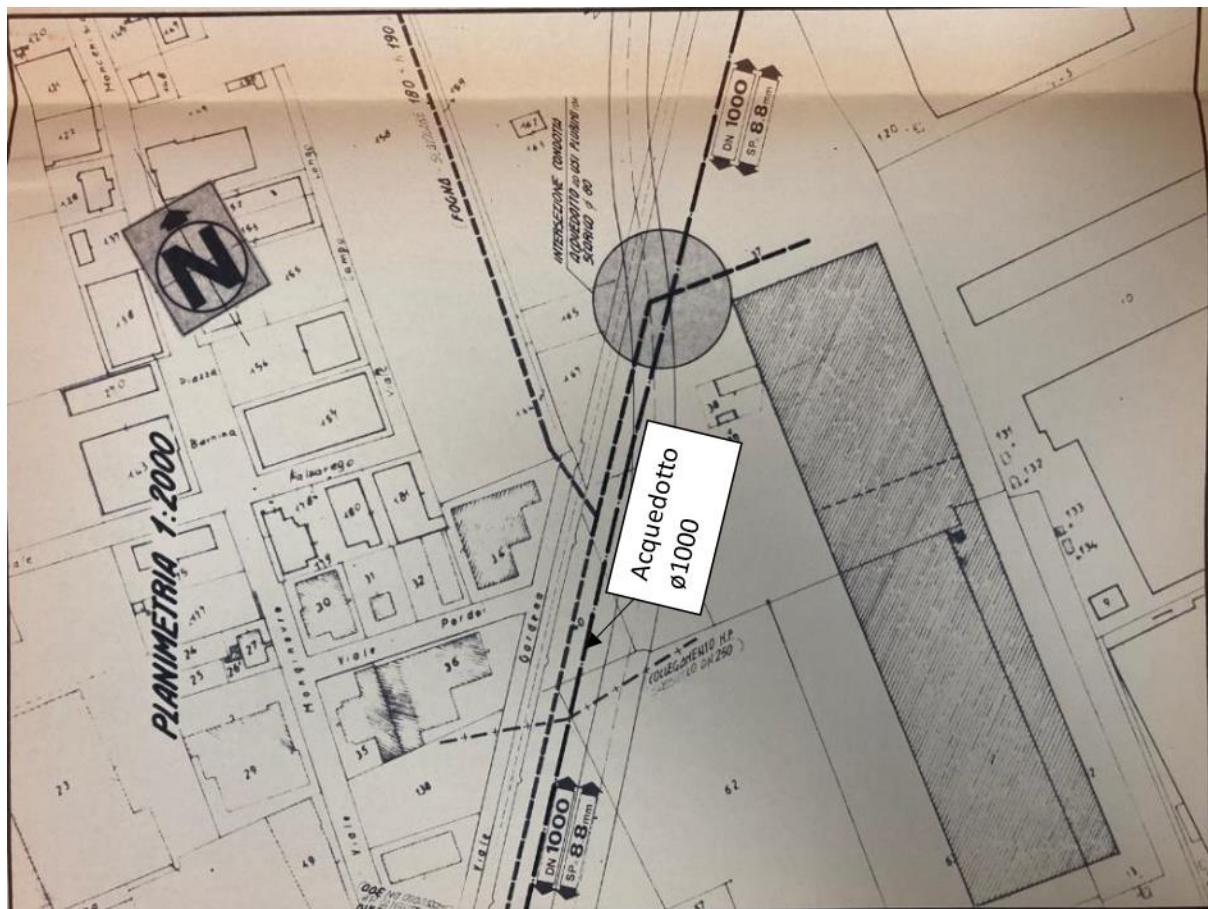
Estratto dalla Planimetria di progetto dell'Acquedotto ad usi plurimi del Secchia
